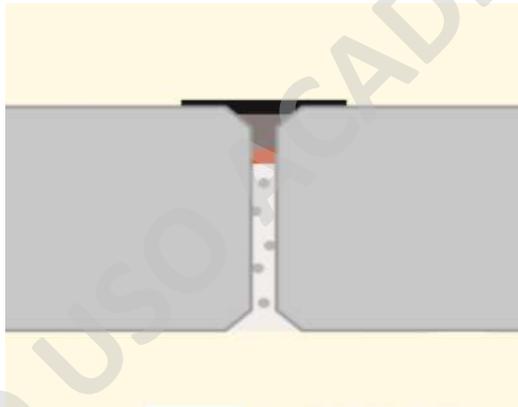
Tratamiento de Juntas - Fuente Bauman.
